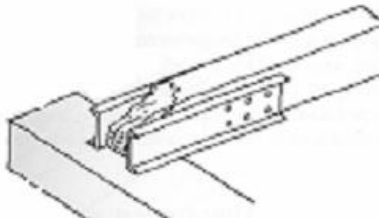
Reforço com utilização de perfil metálico. Fonte: Sanchez (2002)
